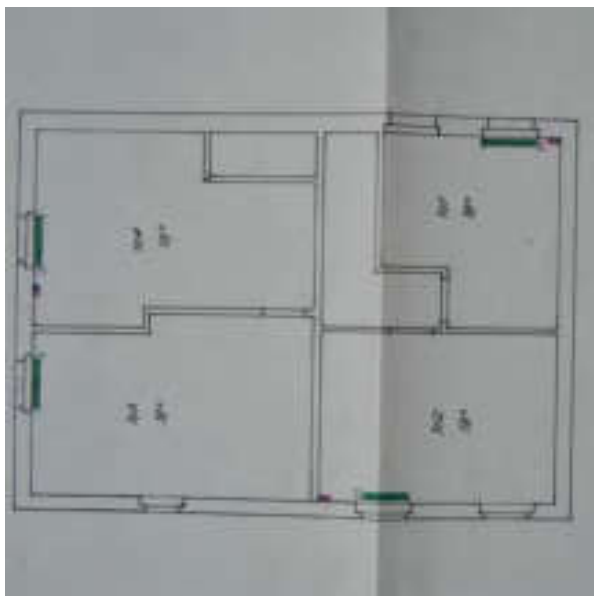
Ausführungsplan Wohnhaus Assek.-Nr. 253, Grundriss Obergeschoss 1:50, 23.09.1971, Pinggera Bauführungen Dietlikon. Quelle: GdeA.
